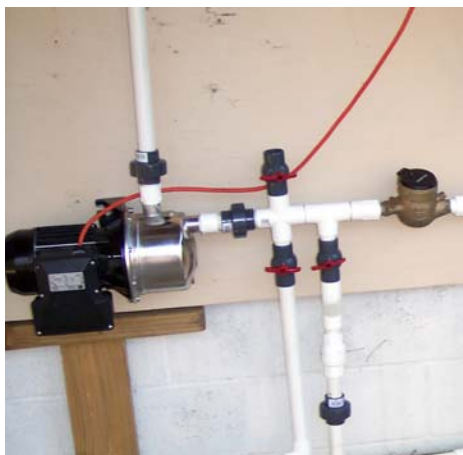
Detalles para cebar una bomba conectada a un tanque sobre el terreno.
